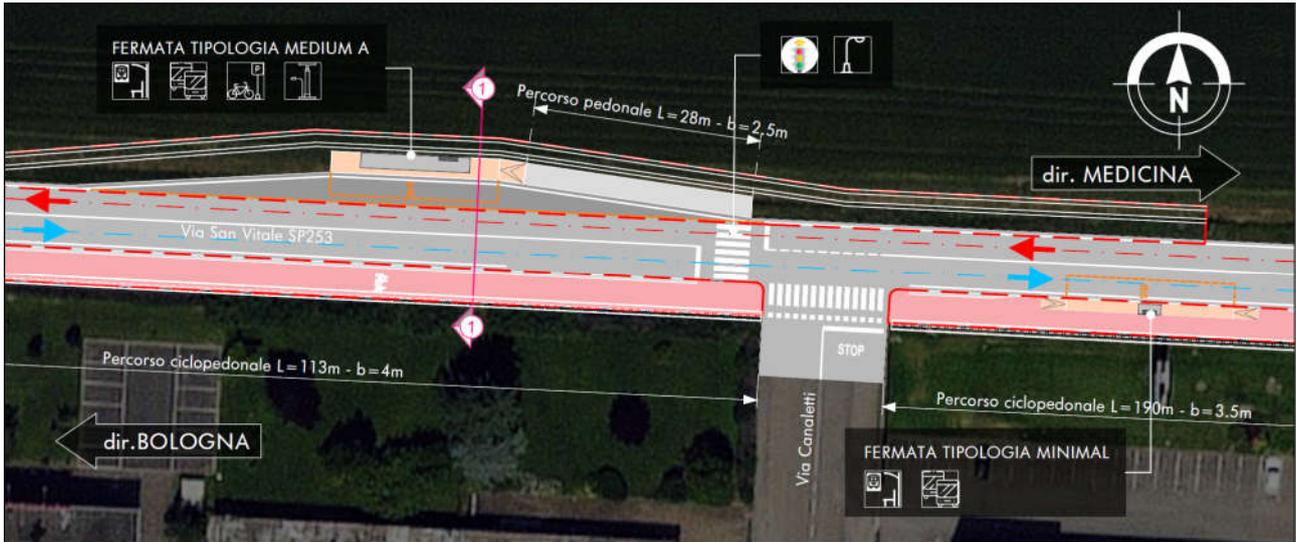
Fermata Canaletti. Focus Planimetria.
